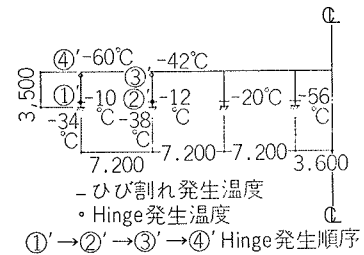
ひび割れ発生および鉄筋降伏発生温度
